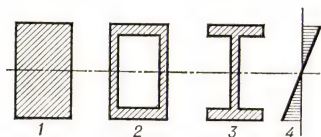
Сечения балок: 1—прямоугольное; 2—коробчатое; 3—двутавровое; 4—распределение нормальных напряжений.
